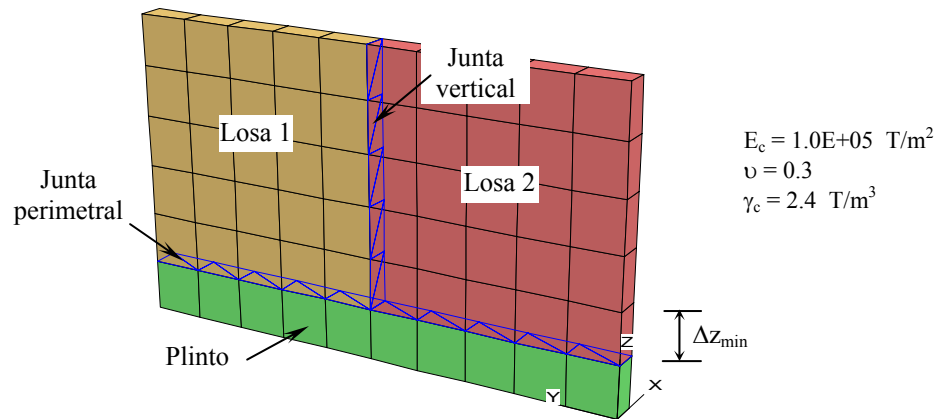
Modelo simplificado de paneles de concreto y juntas constructivas
